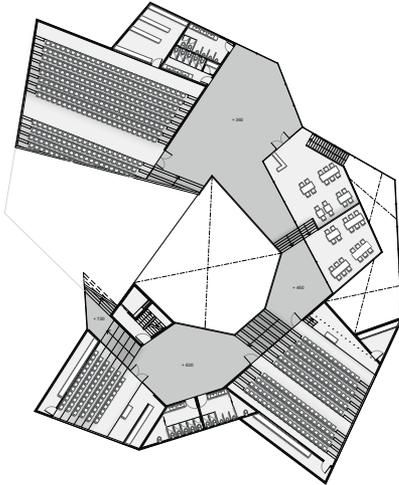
Grundriss +360 bis +720 cm
